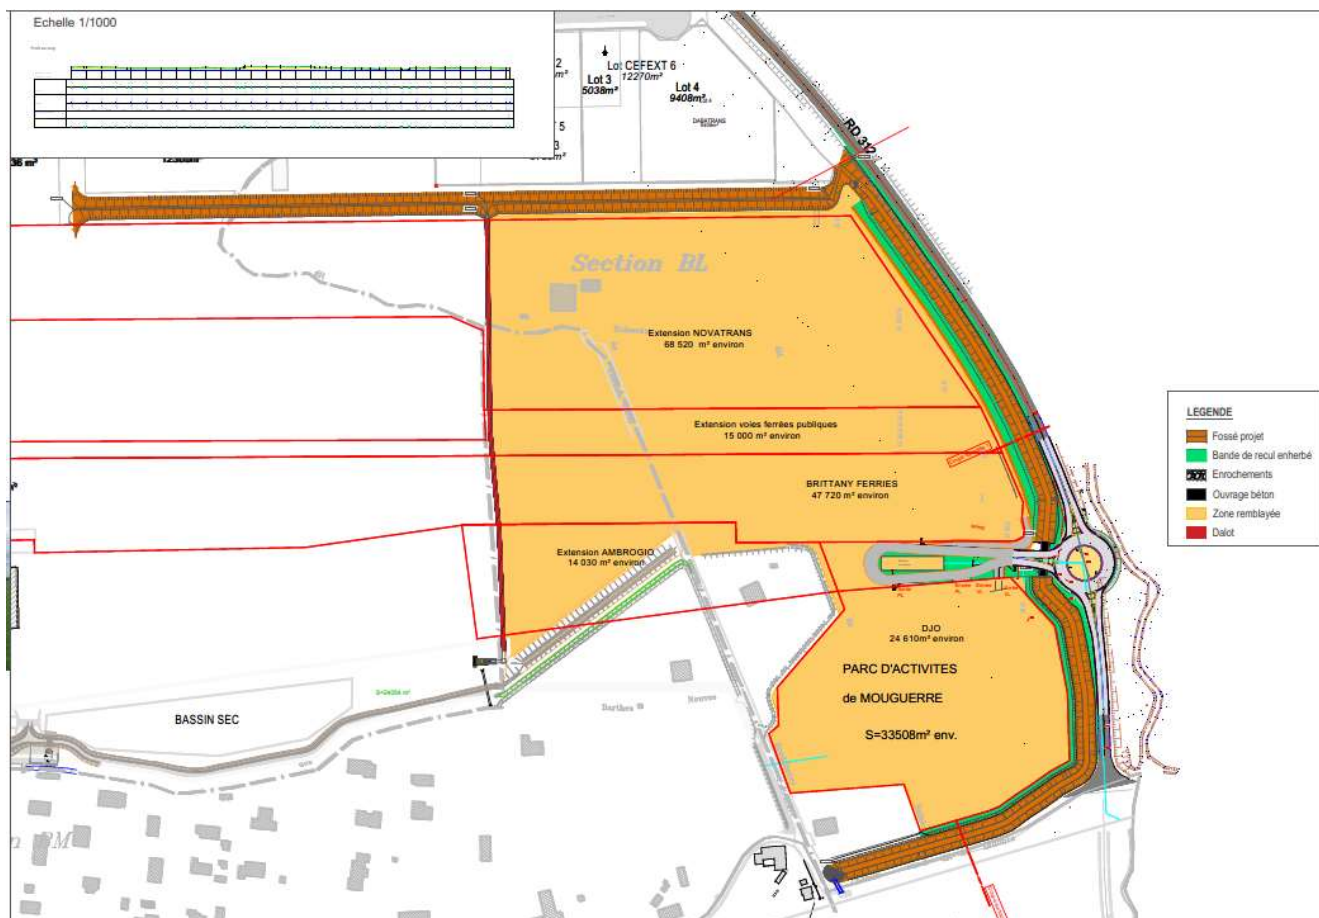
Extrait du plan d'aménagements hydrauliques projetés (plan joint en pièces PA4)
